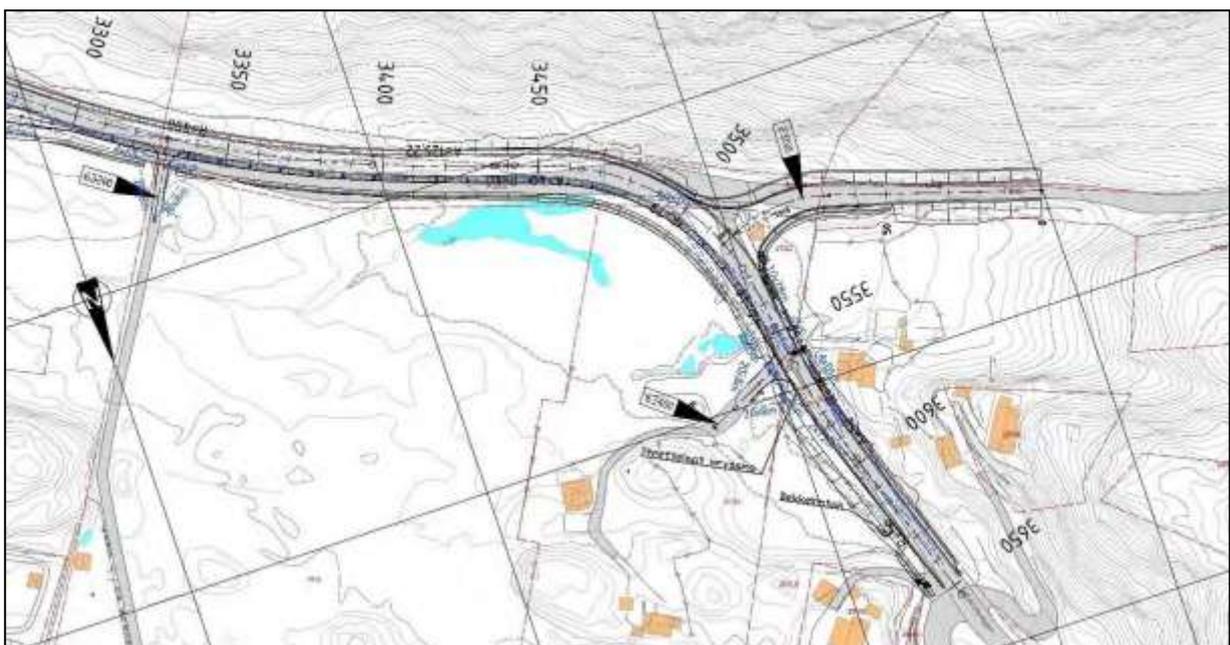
; Avkøyrsla til eigedom 26/25 sanerast og det etablerast ein nyavkøyrsel på gamal driftsveg.
